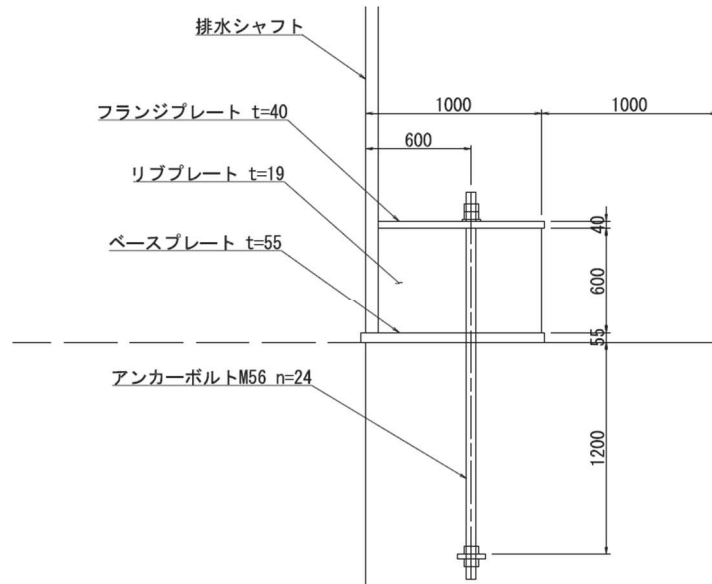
(2) 接合部の構造概要 No.2 揚水井戸 (単位: mm)
